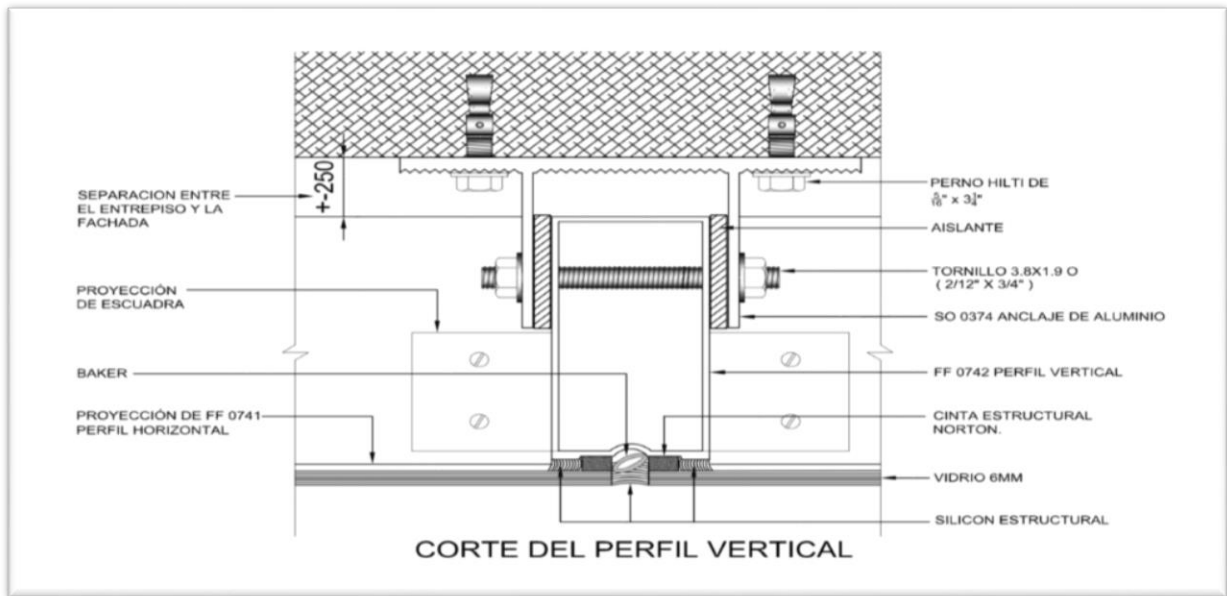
Detalle de anclaje, corte del perfil vertical. Fuente: (Extralum, 2019)
